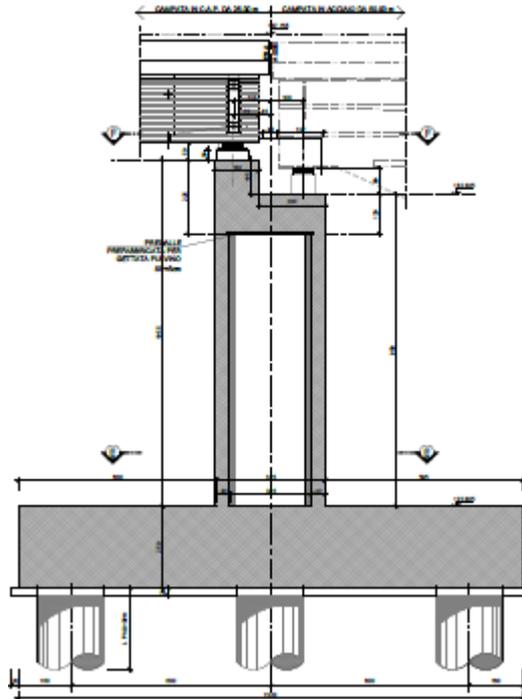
Sezione in direzione longitudinale rispetto all'asse del viadotto
